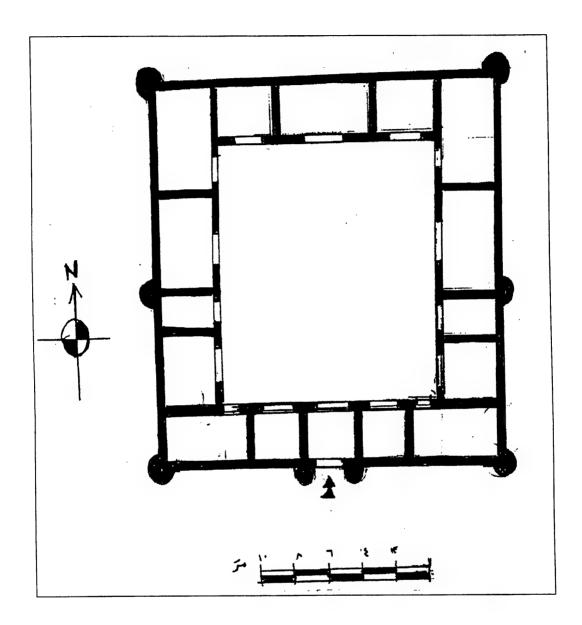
مسقط أفقي لبقايا المبنى السكني (ج) بمدينة الجميرا
